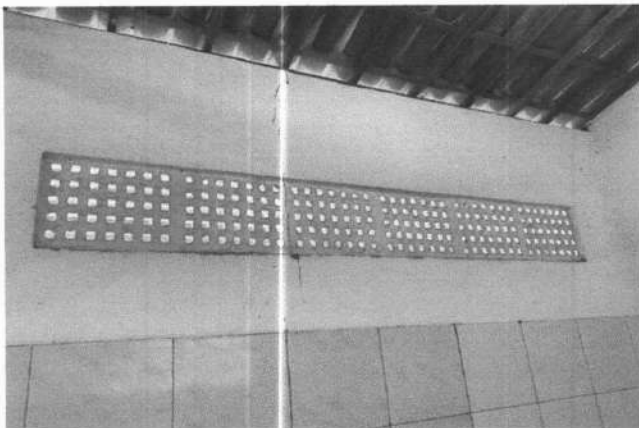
NECESSIDADE DE REFORÇO ESTRUTURAL
